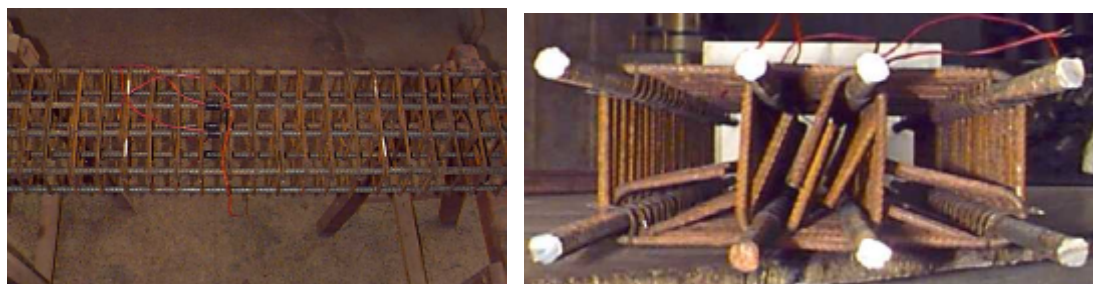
Detalhes da armadura do pilar P1/1
